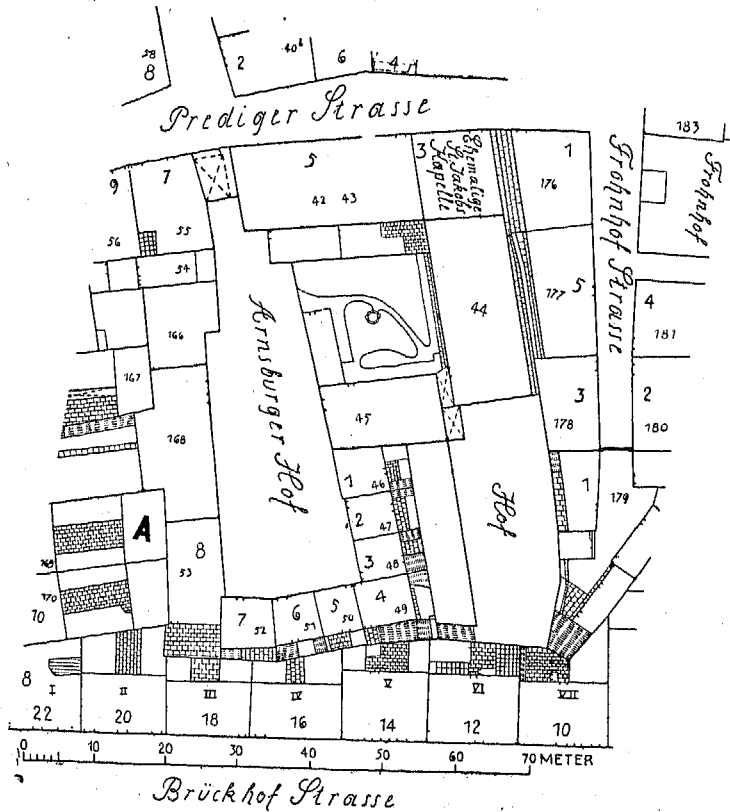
Arnsburger Hof; Grundriss nach dem Katasterplan. 1:1000.
